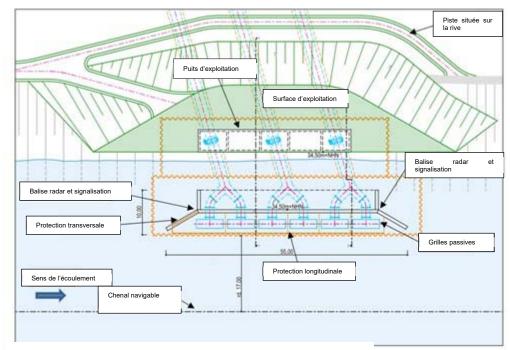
Plan de situation de l'ouvrage de prise d'eau
